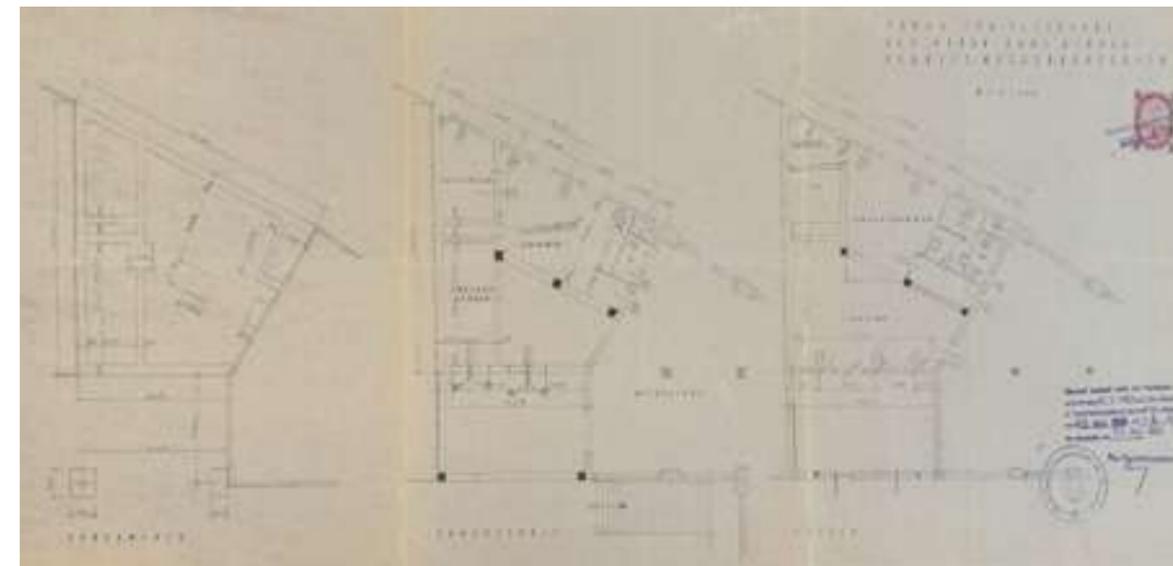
Grundrisse Gebäudeteil 2, 1963
